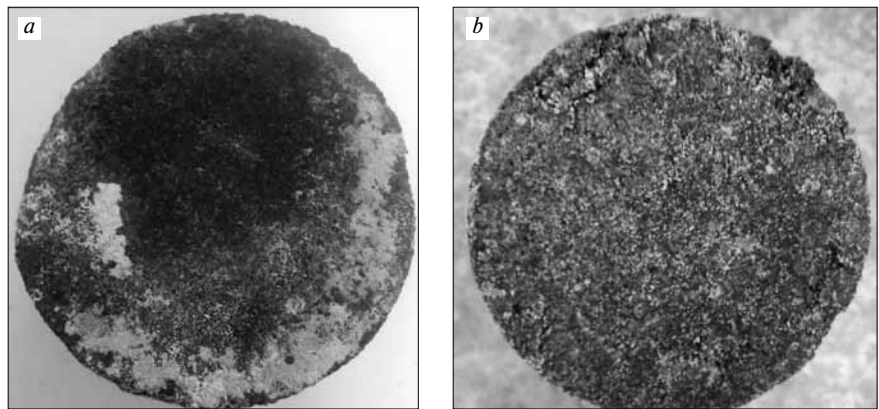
Внешний вид образцов после ускоренного испытания на высолообразование: а – контрольный образец; б – образец с микрокремнеземом
